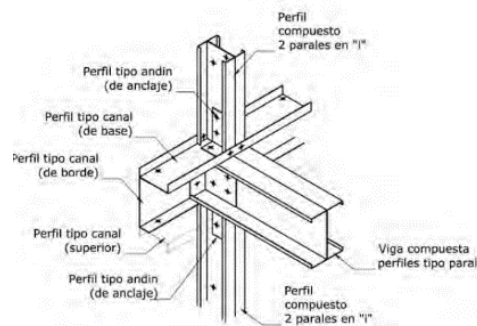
Perfiles Metálicos. *FUENTE: Estructura Metálica de Soporte Camacol-Valle
